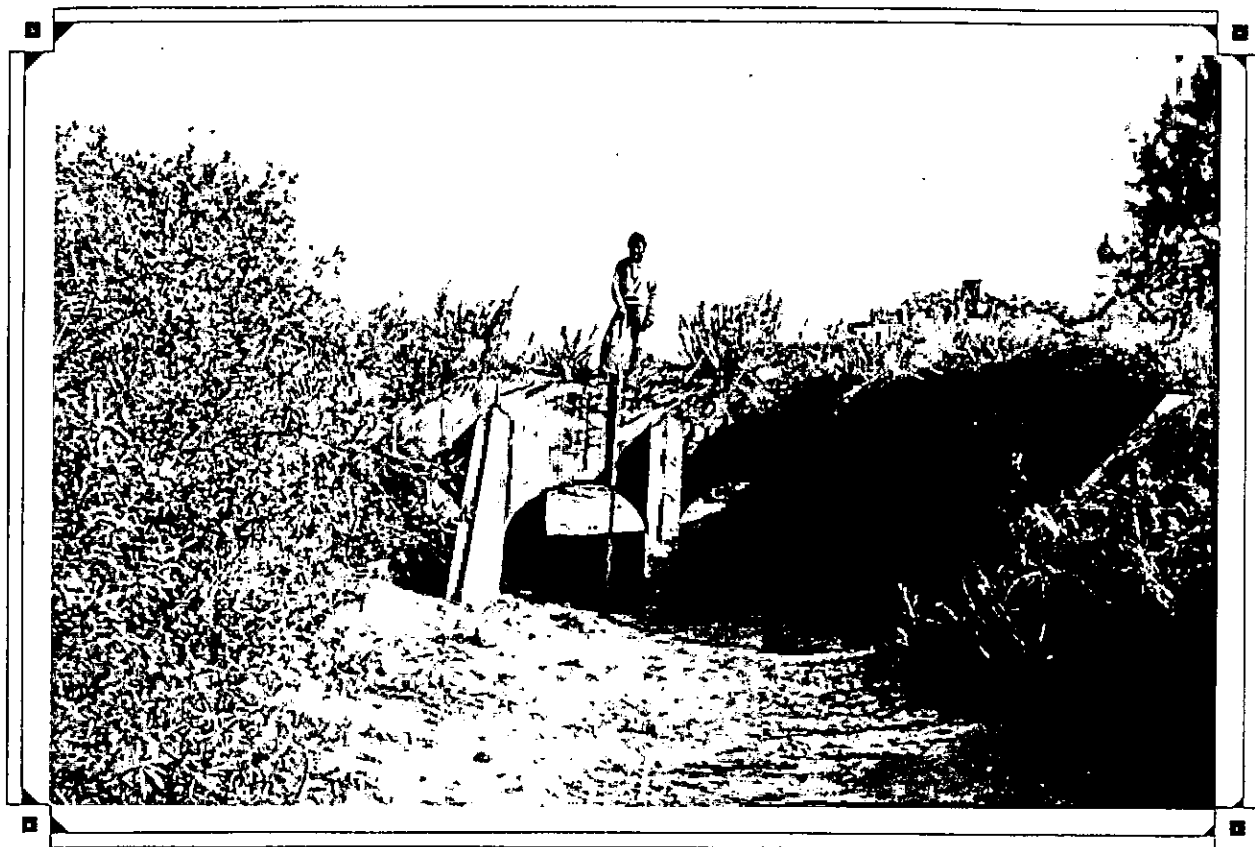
Alcantarilla a readecuar (Desbarre)
